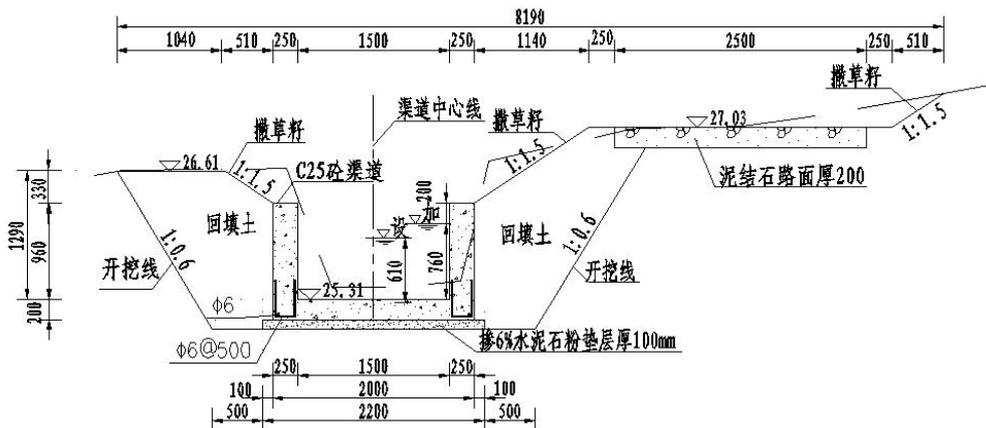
大坑灌区总干渠 Z0+063~Z7+160 段典型断面图
